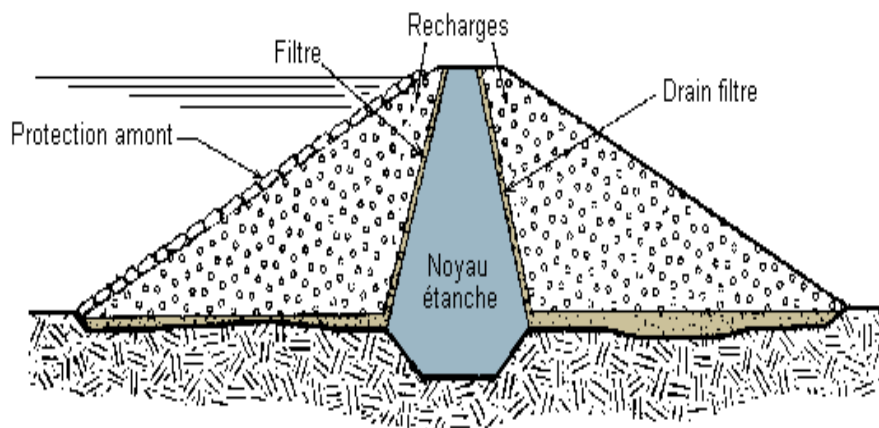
Schéma d'un barrage en terre à noyau étanche
